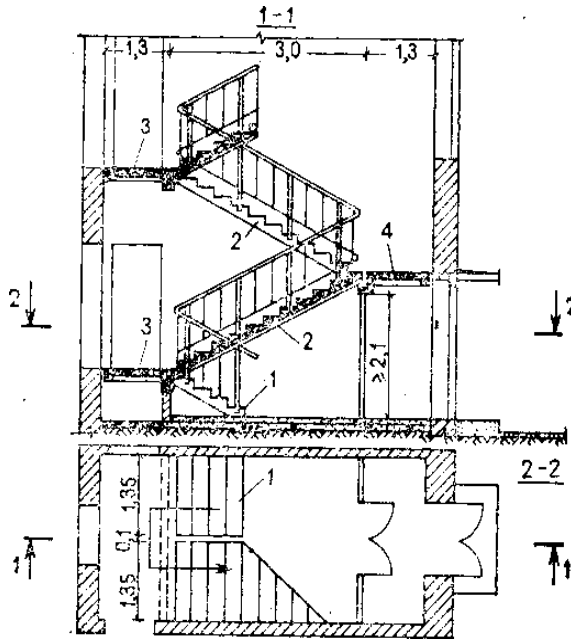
Розріз та план сходової клітки: 1 - цокольний марш; 2 - рядові сходові залізобетонні марші; 3 - збірна залізобетонна сходовіа площадка; 4 - проміжна сходовіа площадка
